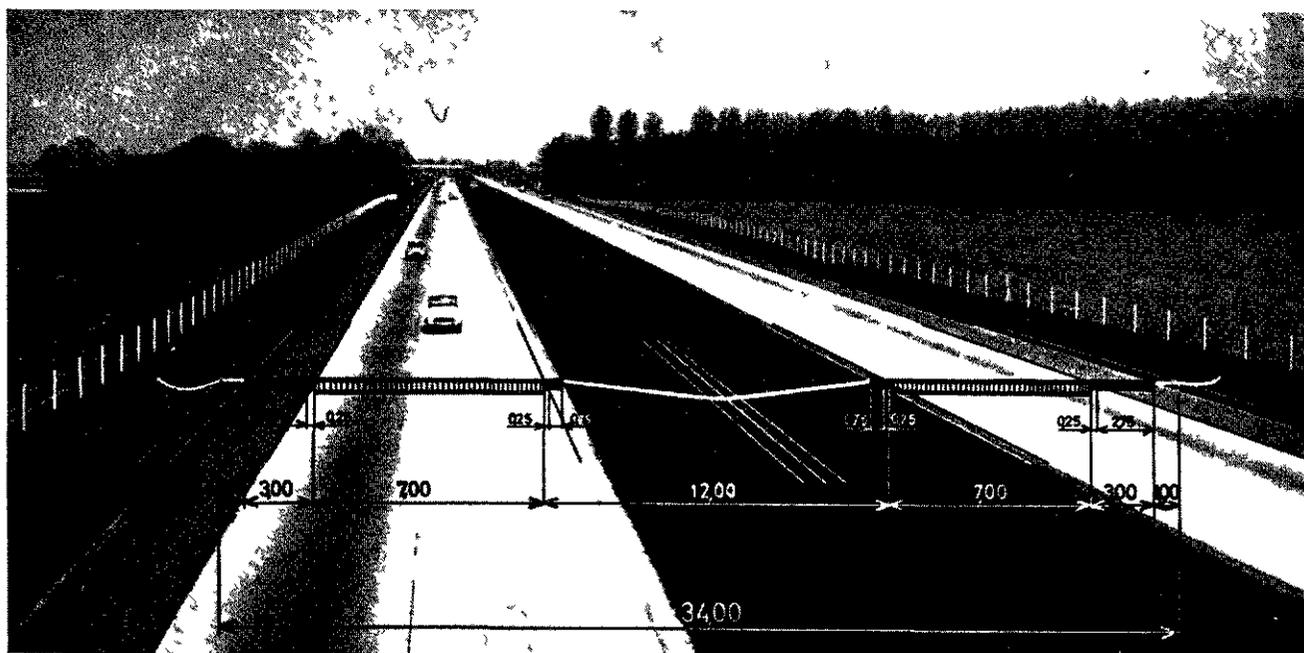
Profil en travers type d'autoroute de liaison récente : le terre-plein de 12 m pourra être réduit ultérieurement à 5 m pour élargir de 7 à 10,50 m chacune des deux chaussées.
